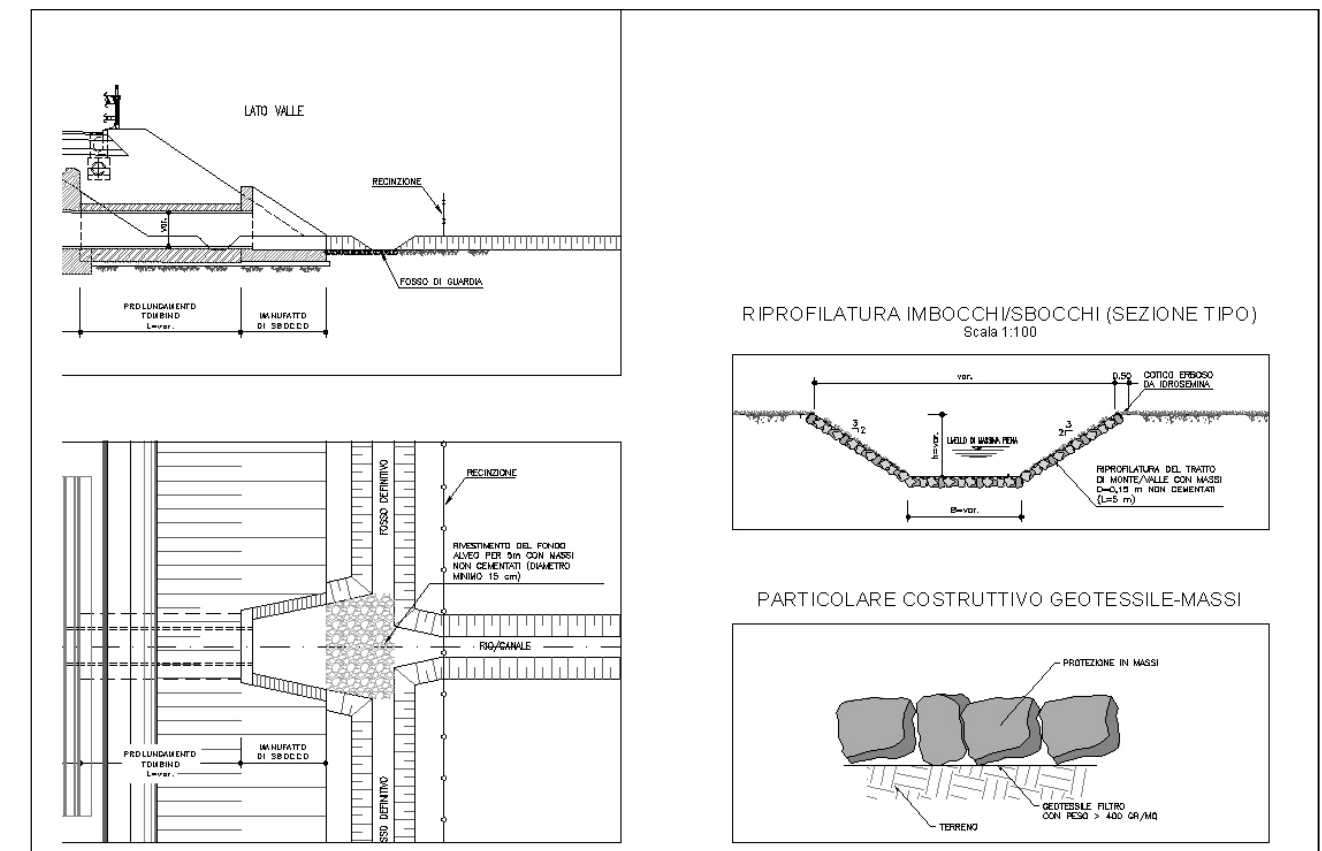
Scolo Desturello planimetria, sezione trasversale e particolari tipo
